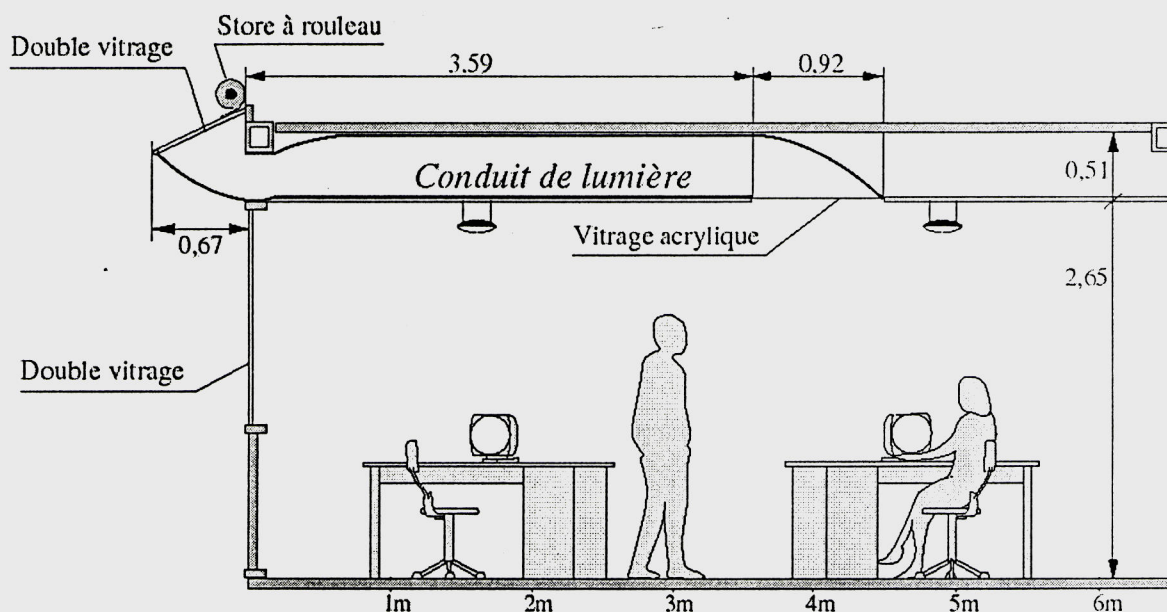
Coupe longitudinale du Plafond Anidolique, installé dans le bureau de test.
